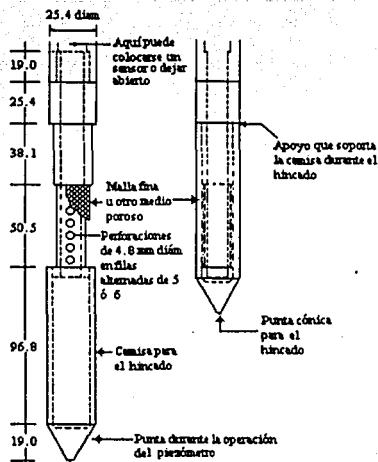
Piezómetro abierto tipo Geonor.
